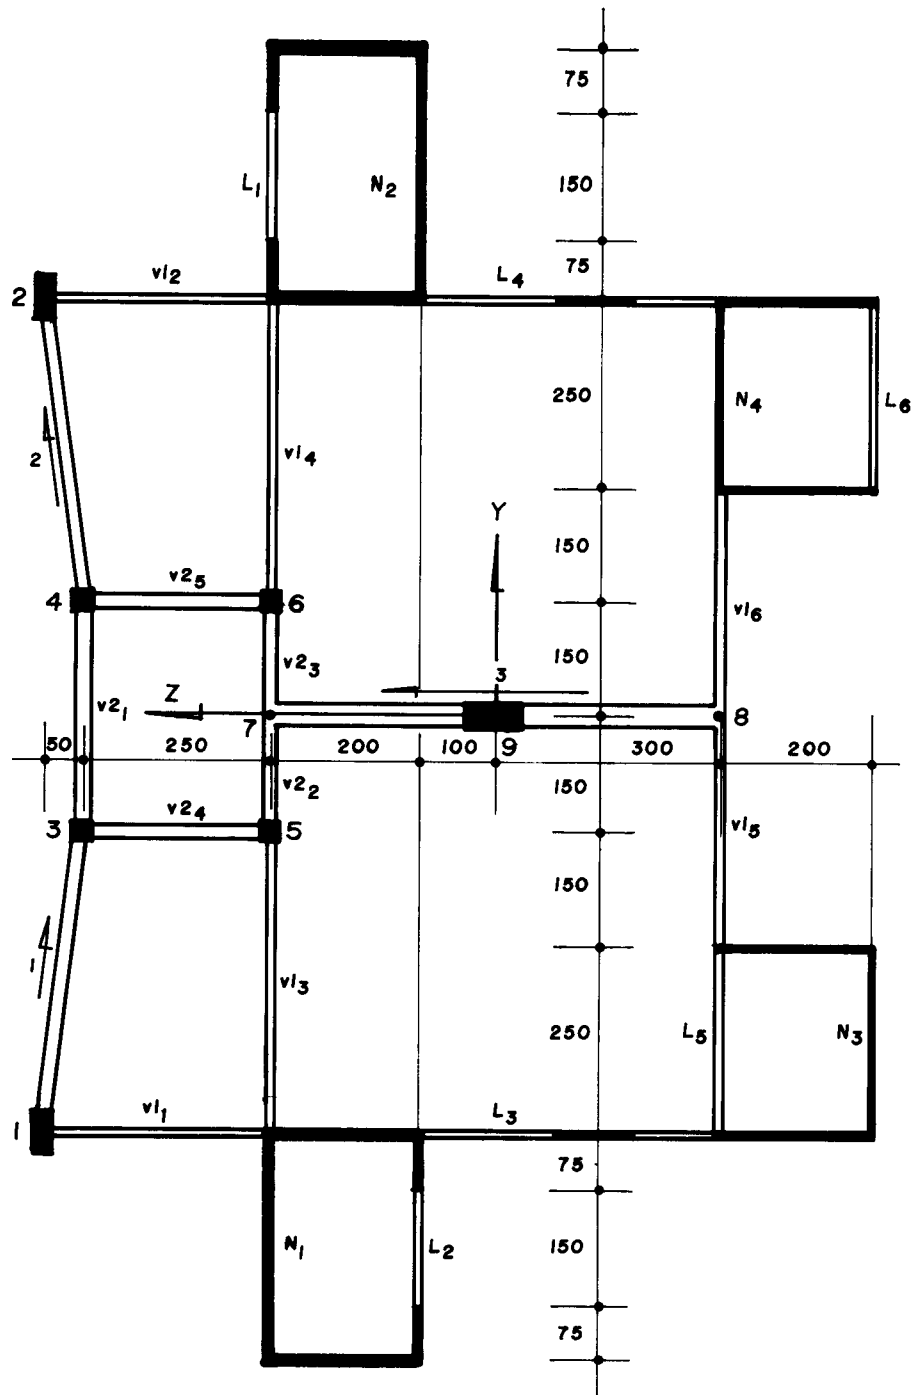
Exemplo nº 5: estrutura (planta baixa).
